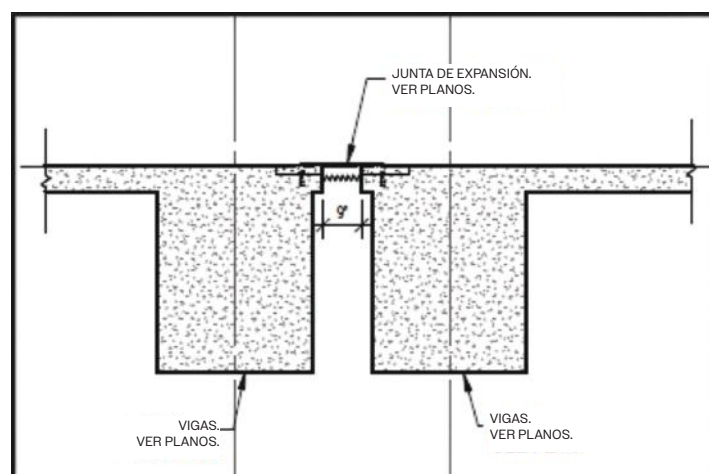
Detalle típico de una junta de dilatación entre vigas en una estructura de estacionamiento.
